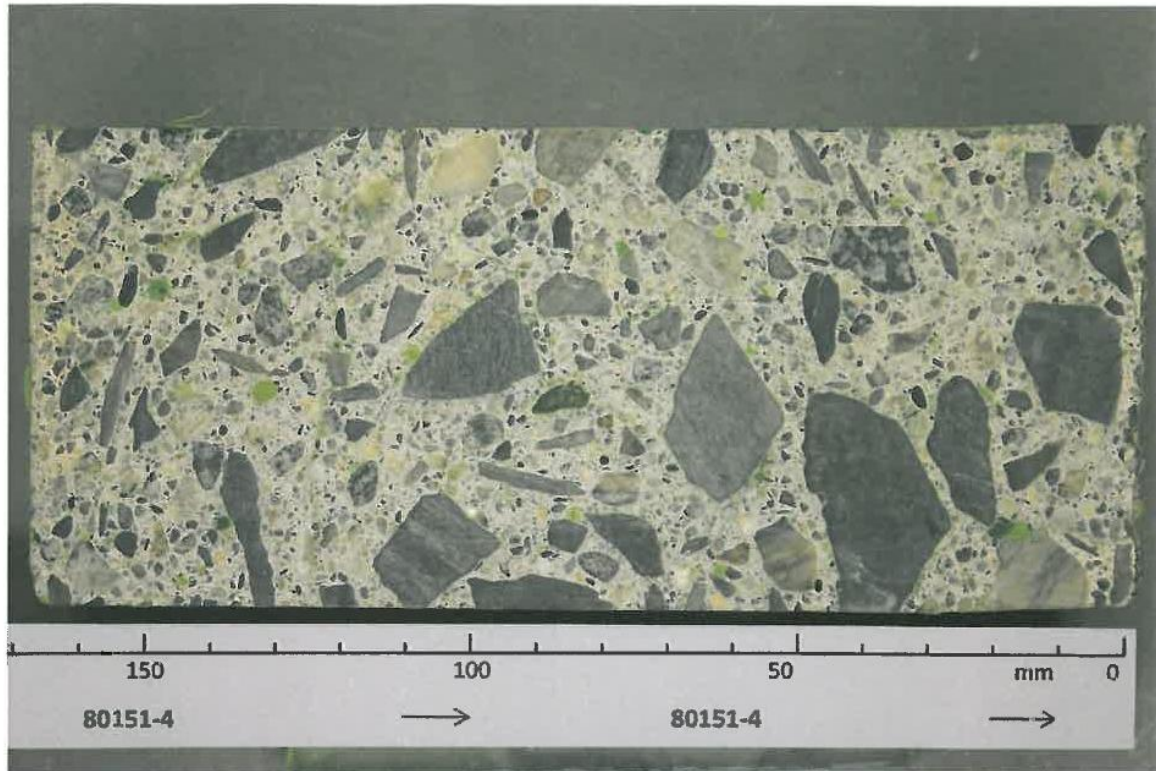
Planslipet fra kjerne Nr 4. Overflaten til høyre på bildet.
